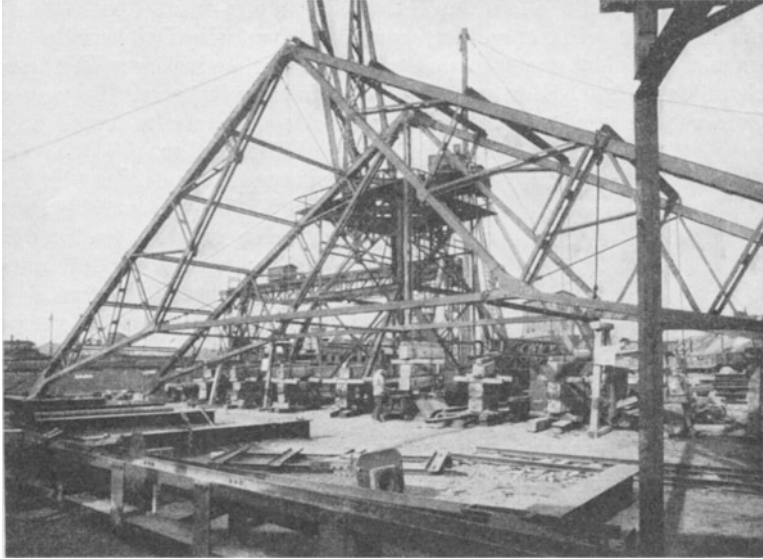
Schweißkonstruktion eines Fachwerkbinders (Probelastung).
